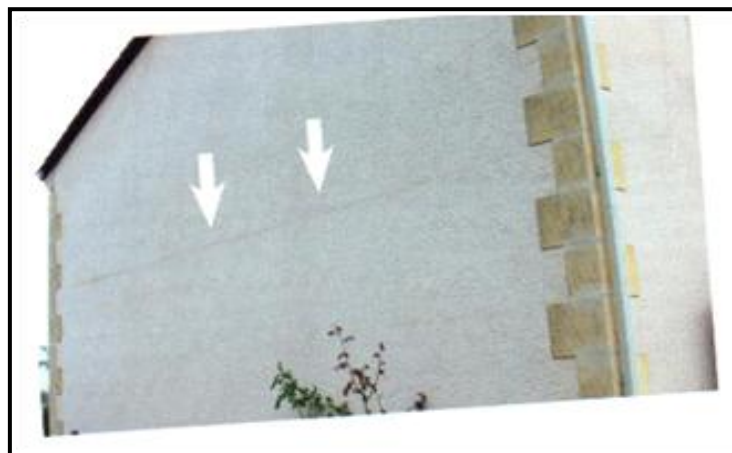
Fissure de plancher une fissure de cette nature ne compromet pas la solidité de l'ouvrage, mais peut laisser passer la pluie.
